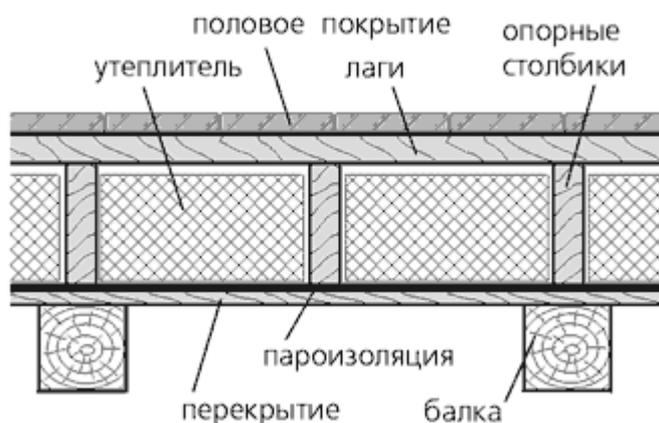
Конструкция перекрытия второго этажа с утеплителем.
